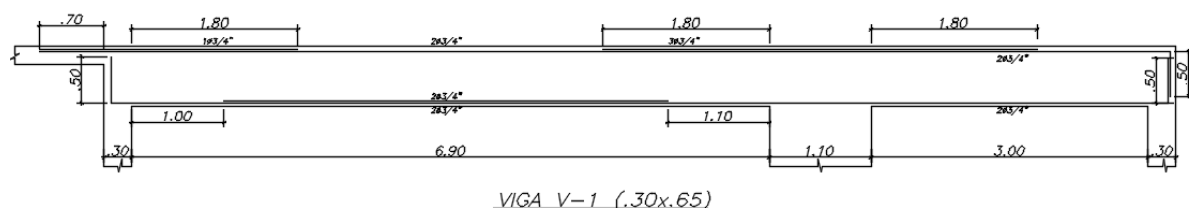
Distribución final del refuerzo por flexión de la viga V-1
